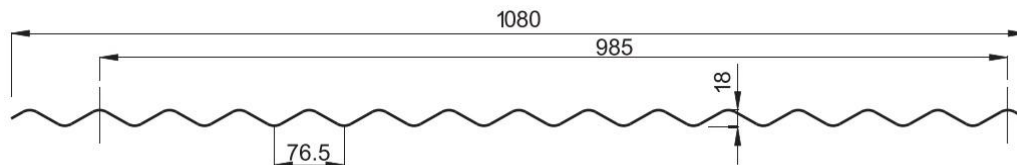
Exemplo de Telha Metálica Ondulada Zincada.
